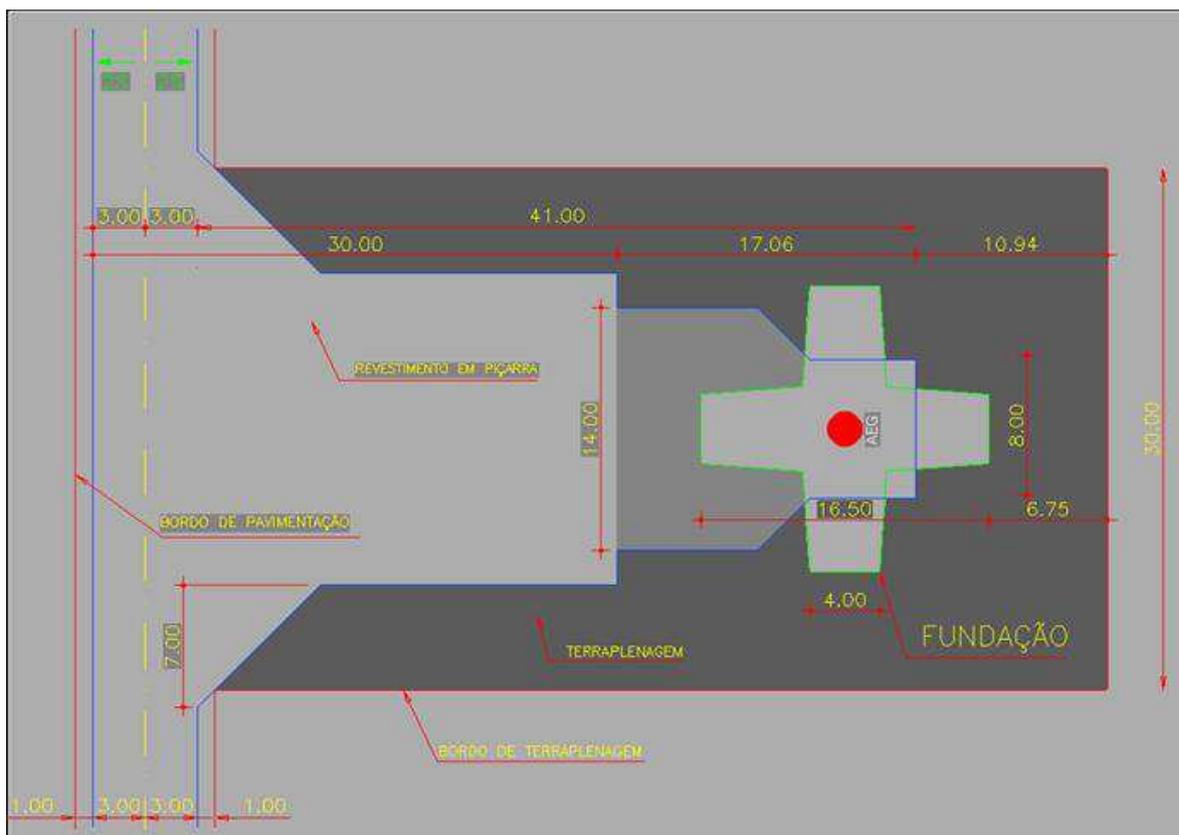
PLANTA BAIXA DA ÁREA DE IMPLANTAÇÃO DE CADA AEROGERADOR
